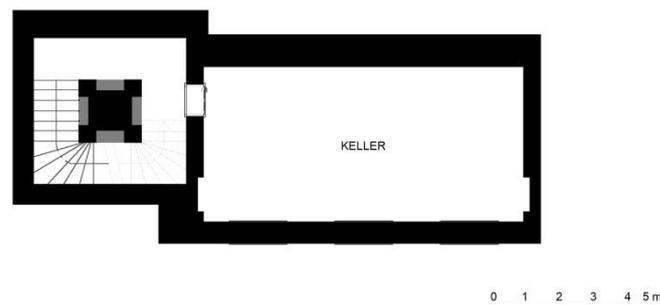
Grundriss Kellergeschoß (ARCHICAD)
